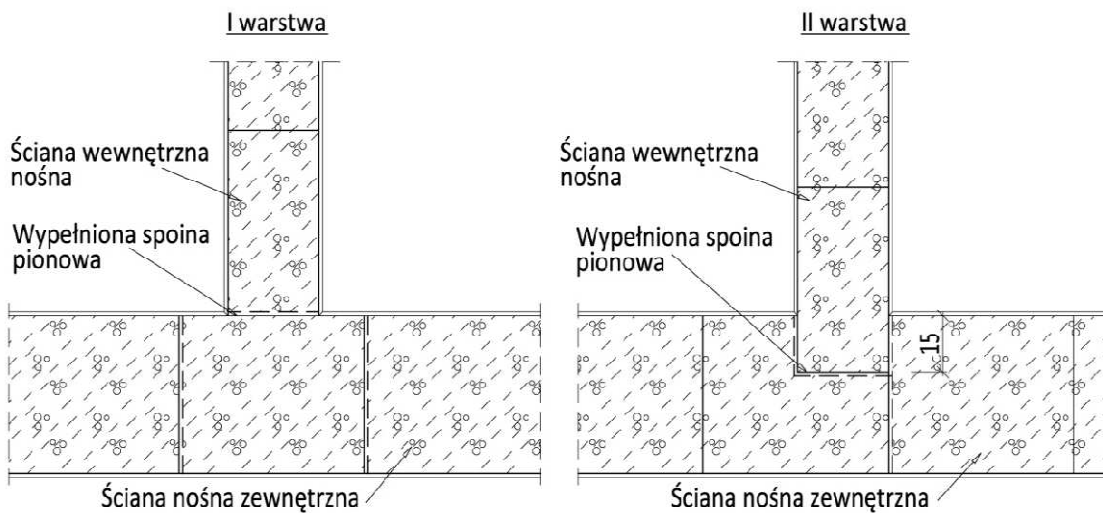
Prawidłowe przewiązanie bloczków betonowych.
